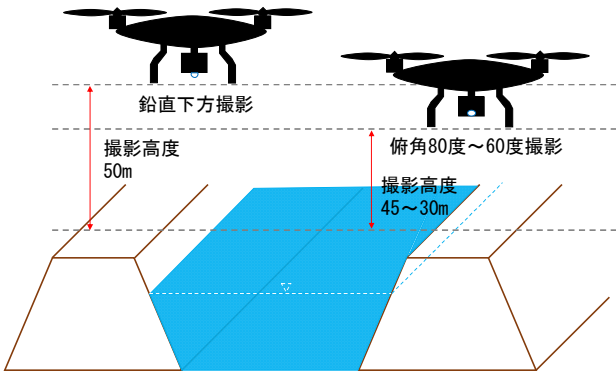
UAV写真撮影のカメラ向き及び対地高度（横断面図）
